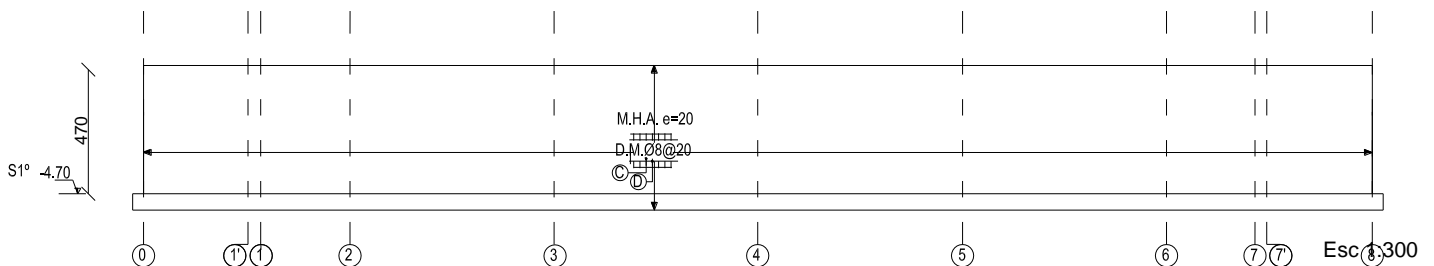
Elevación eje A de edificio aislado. Esc 1:300
